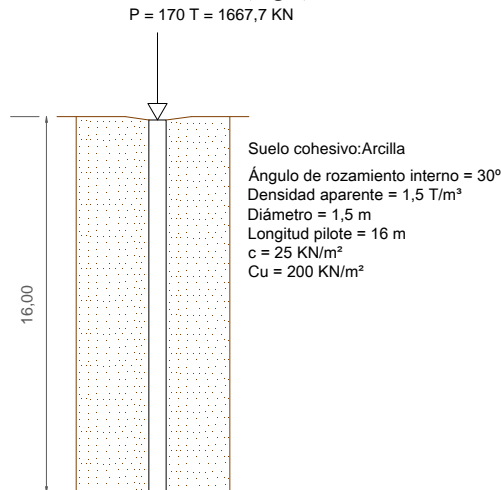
Croquis de pilote con diámetro 1,5 m y longitud pilote 16 m
